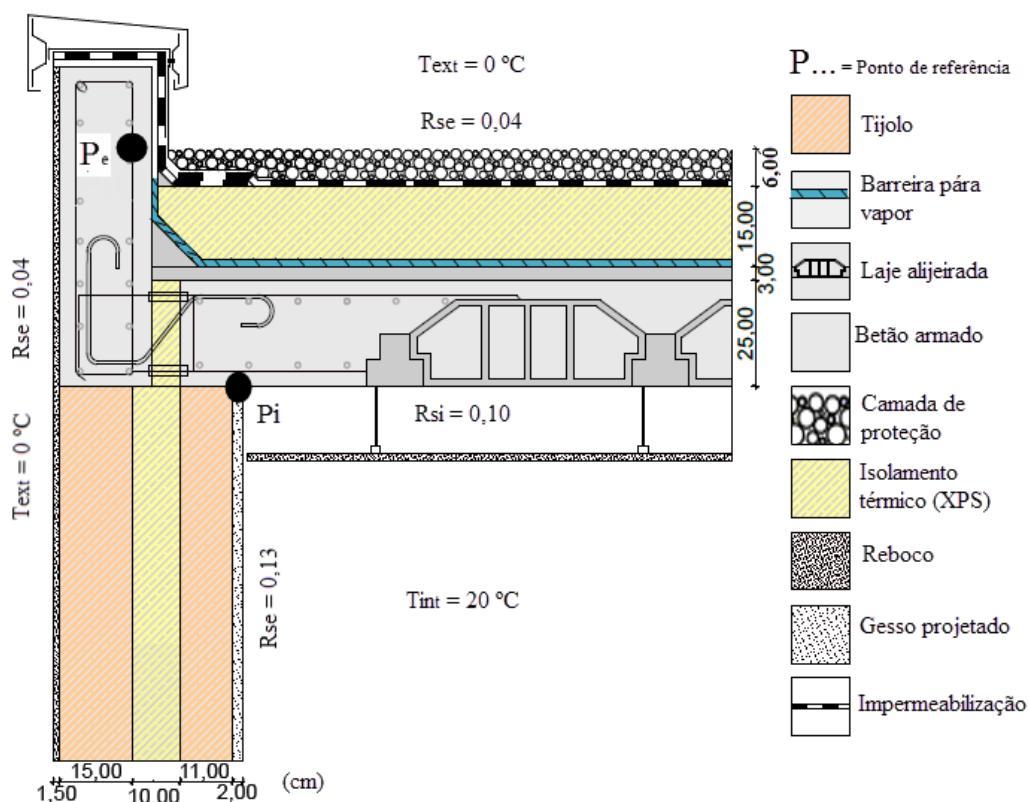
Ligação de fachada (parede dupla) com cobertura plana (sem platibanda)
